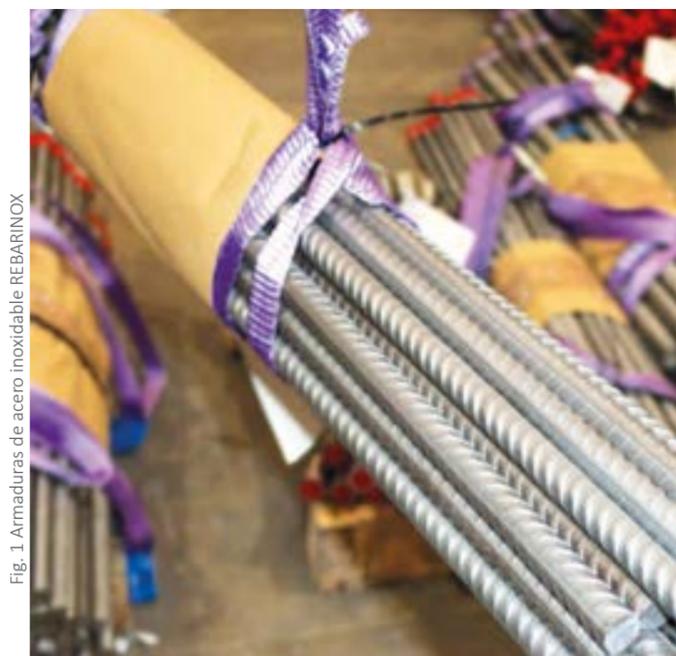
Armaduras de acero inoxidable REBARINOX.
